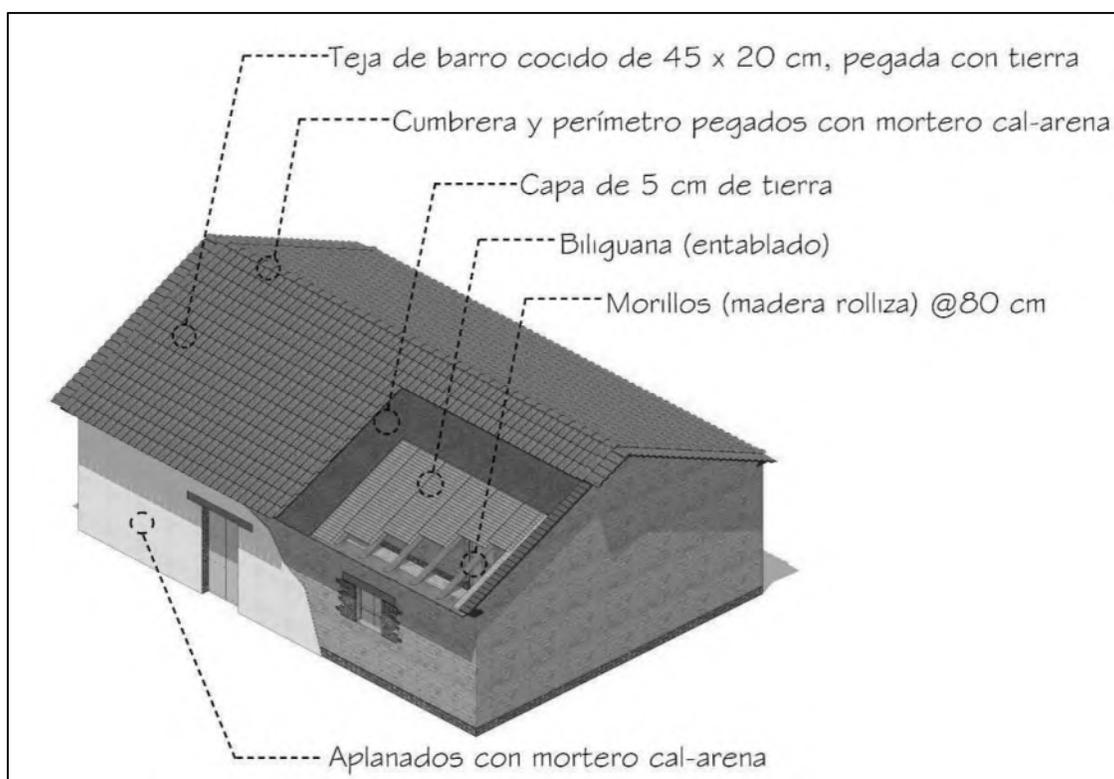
Proceso constructivo de la casa de adobe. Cubierta y acabados. Fuente: elaboración propia.
